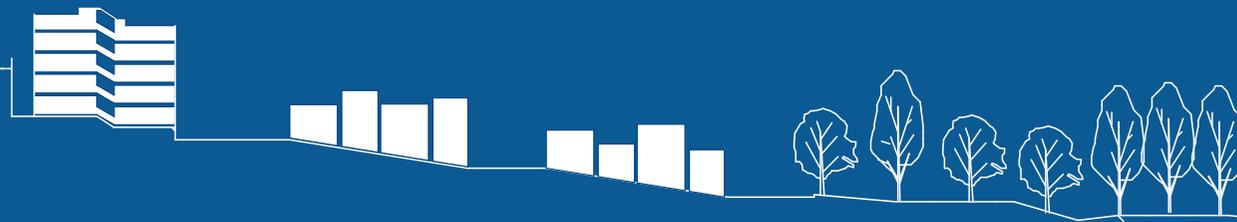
Vásquez E. (2019). Espacios públicos interiores en planta baja.
